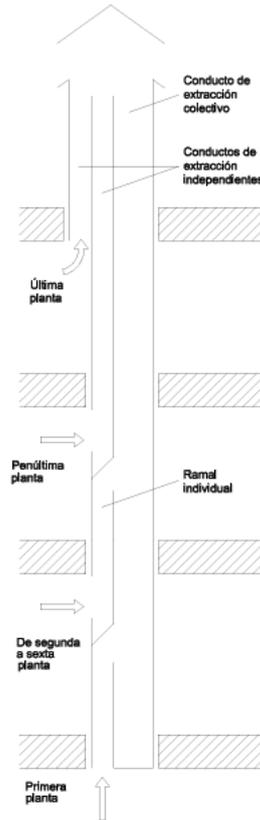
Conducto de extracción para ventilación híbrida con conducto colectivo. Fuente: CTE HS-3
